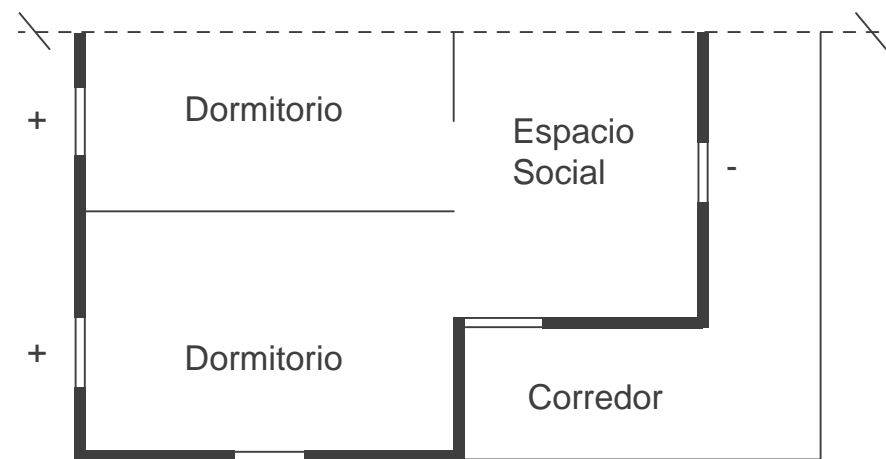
Representación en planta prolongación de la fachada frontal, arquitectura local. Realizado por el autor.
